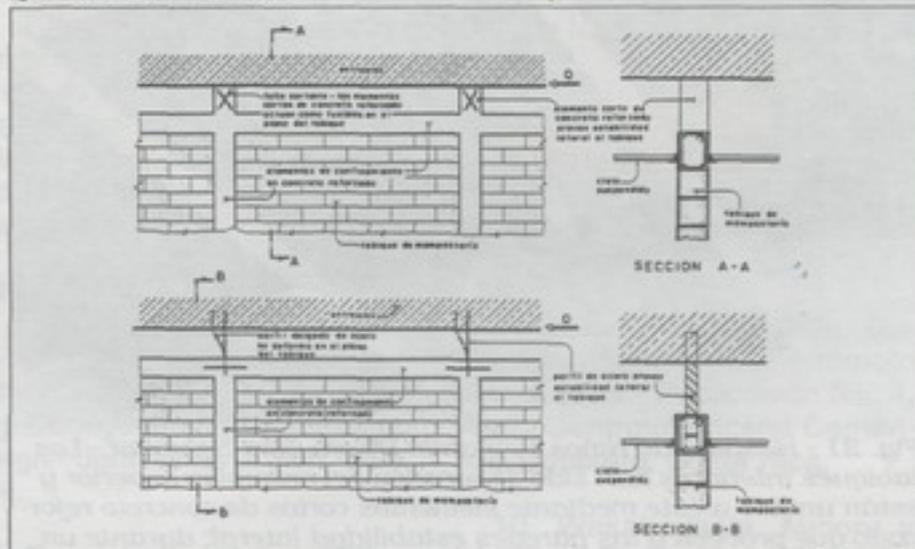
Detalles constructivos tendientes a separar los tabiques del entrepiso superior y a proveer a la pared estabilidad lateral en sentido perpendicular a su plano.
